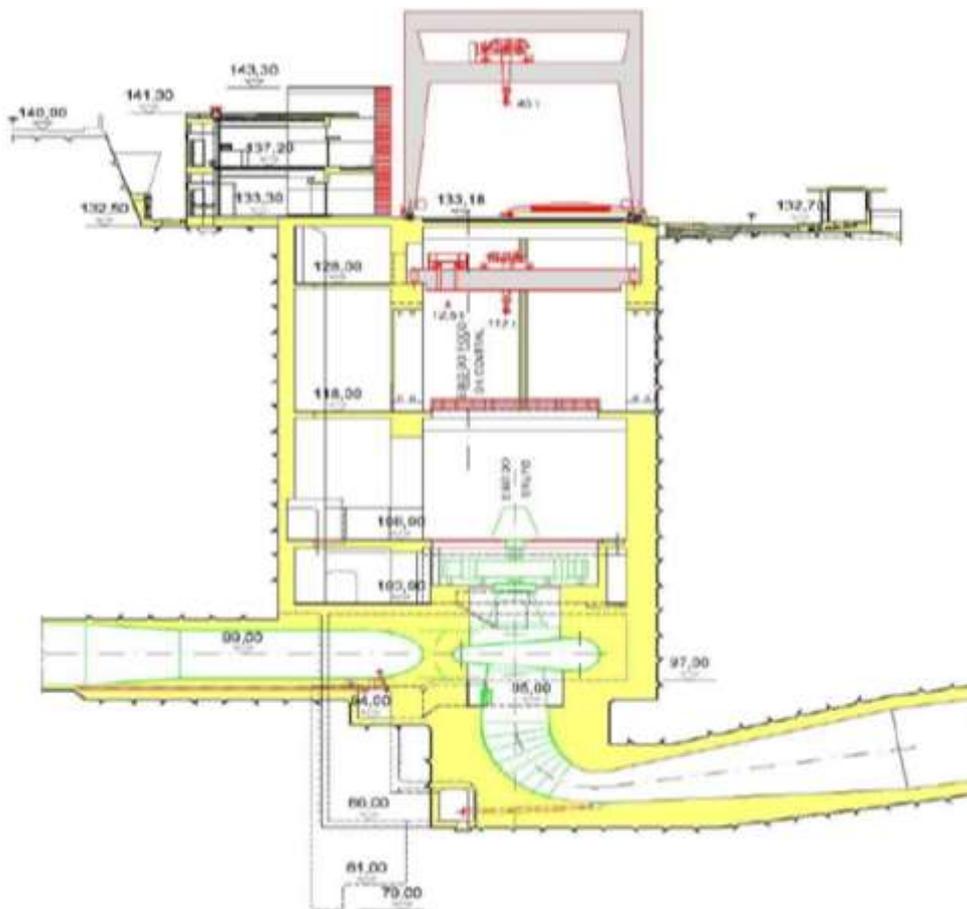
Central e Edifício de Apoio (Corte Transversal) (6)
